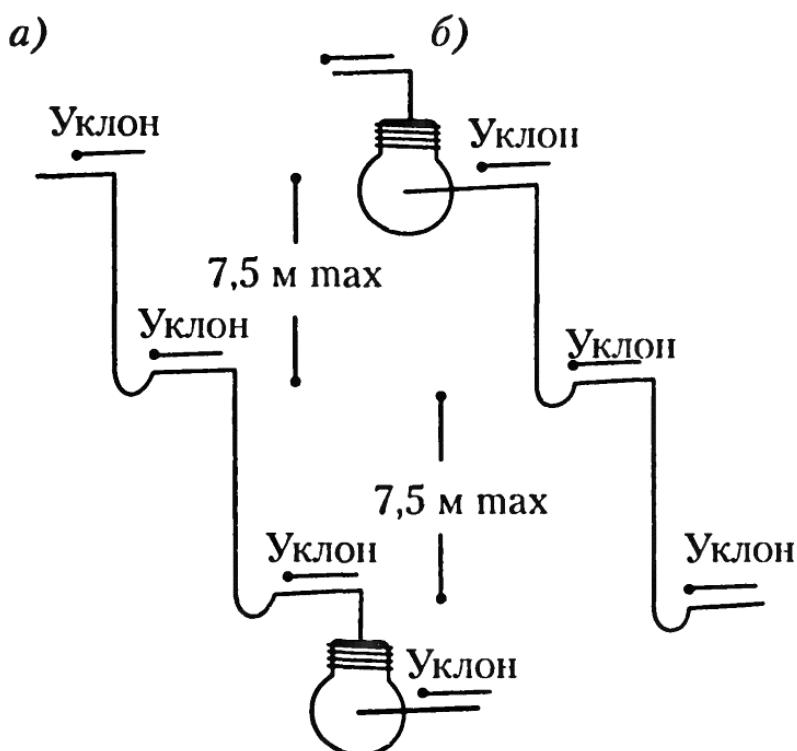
Схема установки маслоподъемных петель на восходящих участках трубопроводов длиной более 7,5 м: а — нагнетательный трубопровод; б — всасывающий трубопровод
